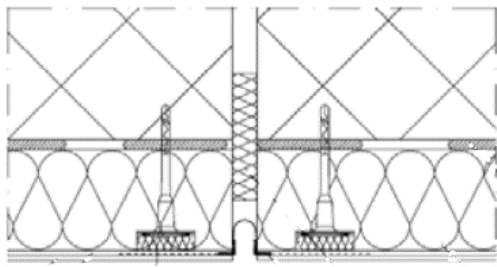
Dettaglio in sezione orizzontale di un giunto strutturale su cappotto.
